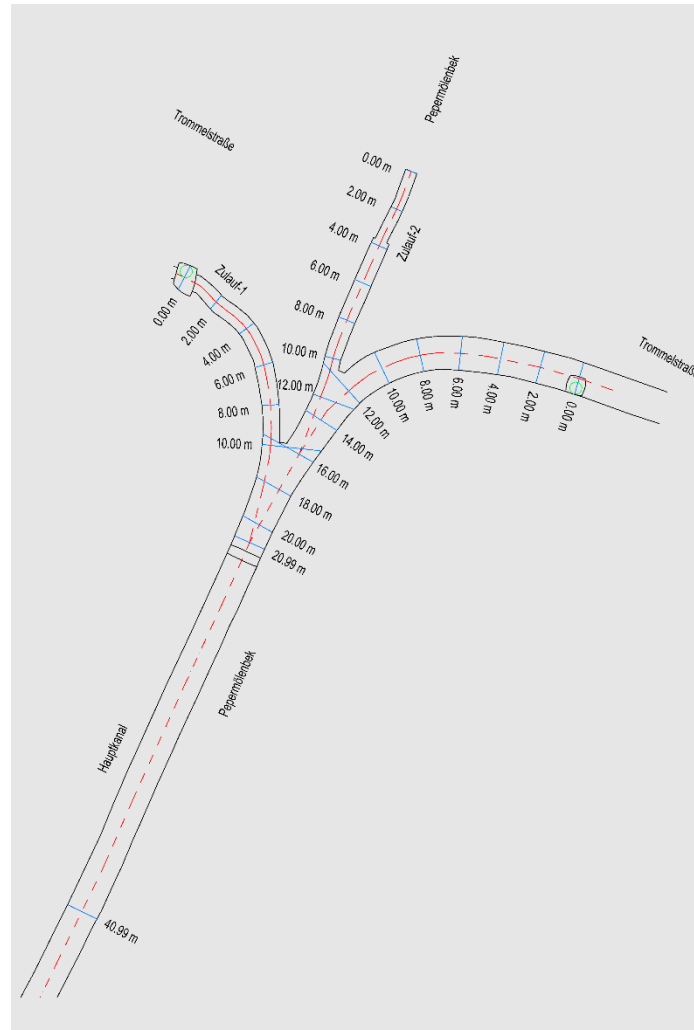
Ausschnitt aus der Grundrisszeichnung
